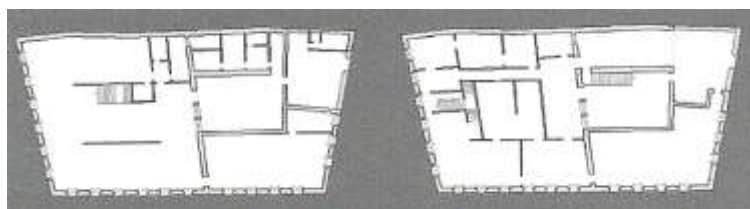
Plantas de reconstrução Térreo: antes e depois da intervenção (1946-1952)
